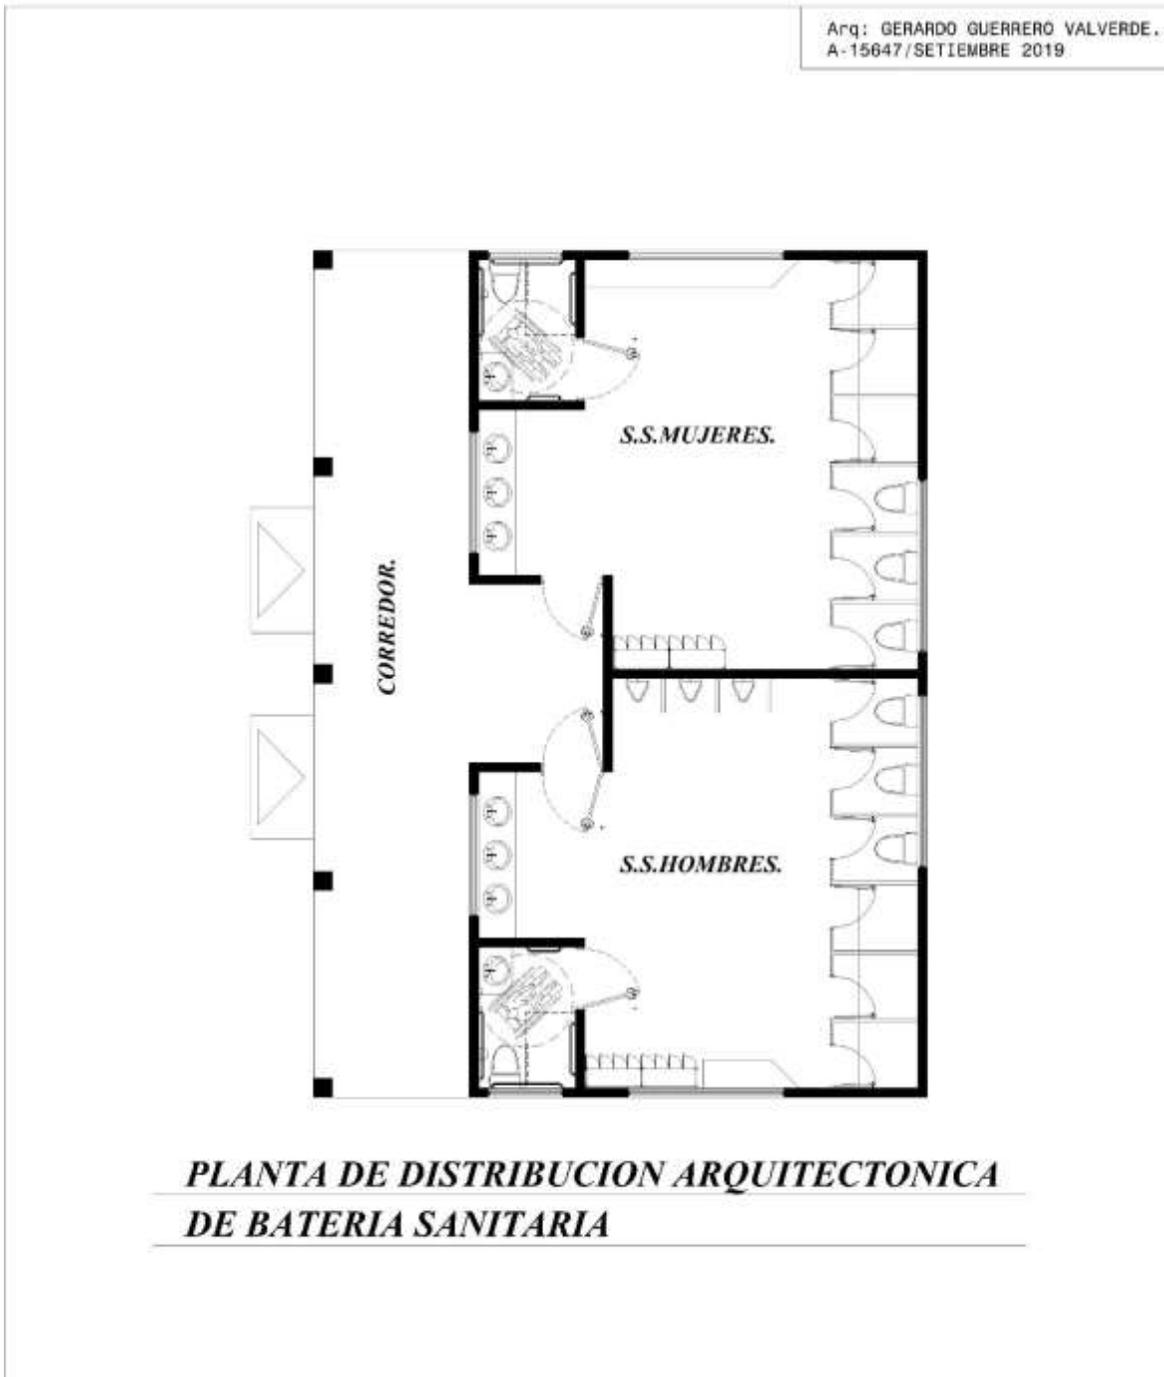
Planta de distribución arquitectónica de batería sanitaria
